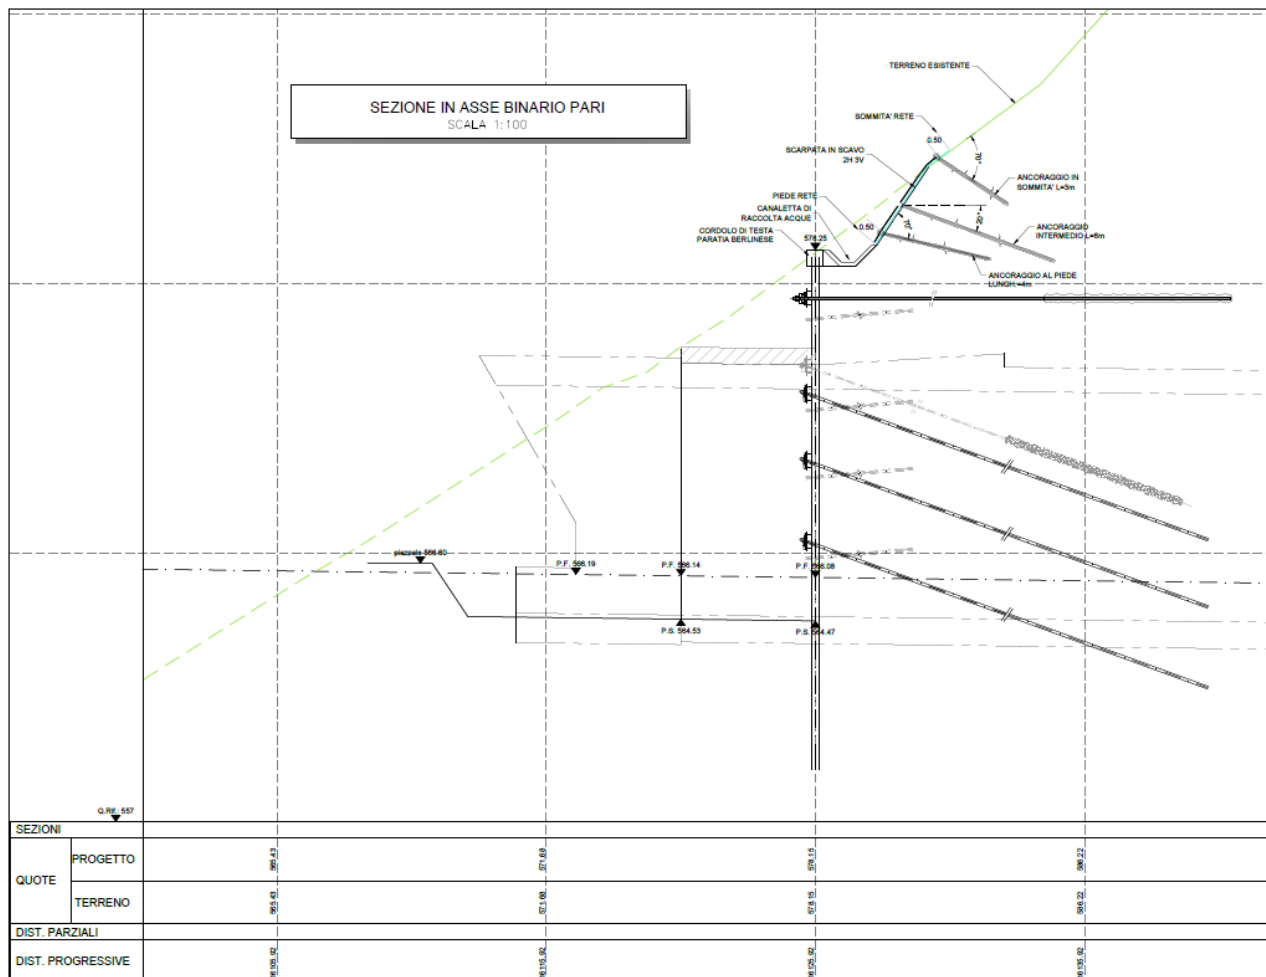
Sezione longitudinale esemplificativa e schematica della soluzione proposta (intervento corticale)
